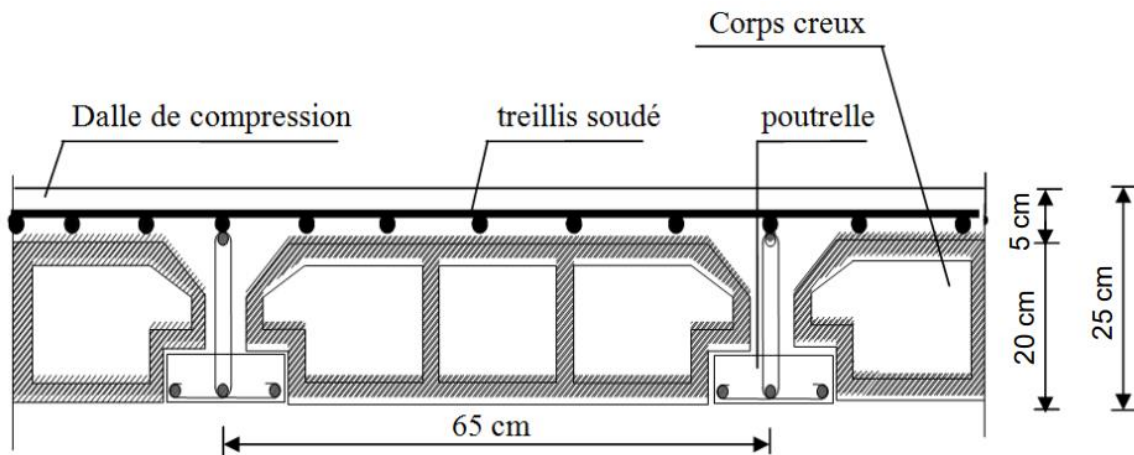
coupe transversale sur un plancher en corps creux.
